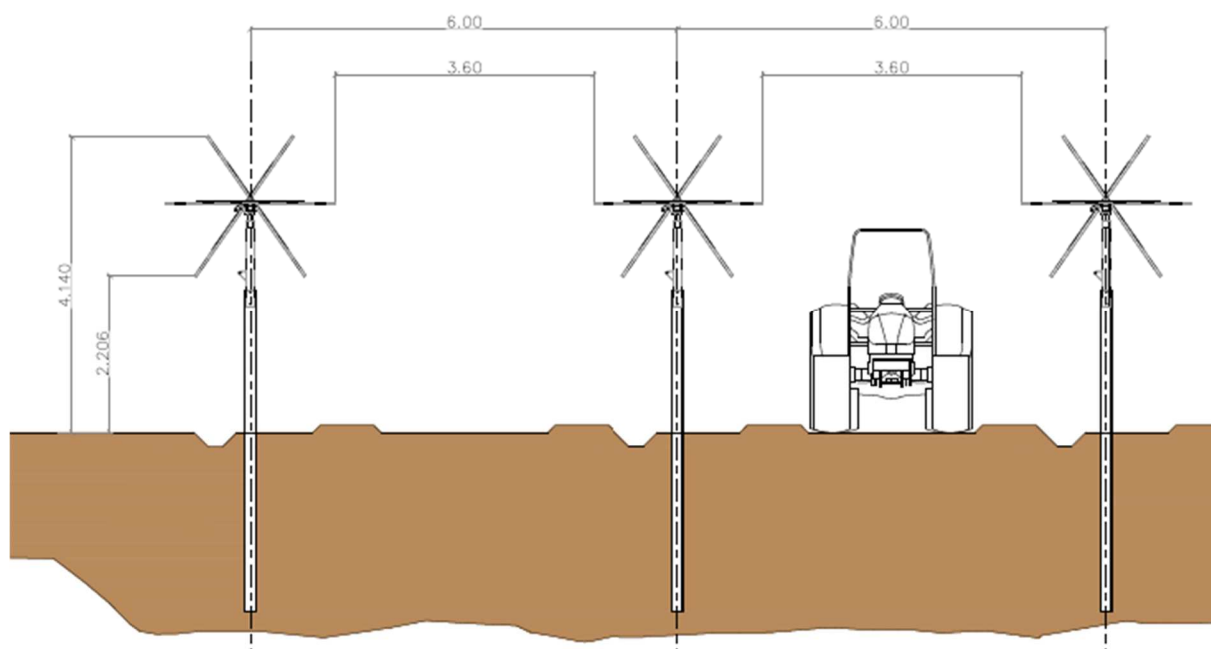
Sezione struttura sostegno moduli con palo di fondazione che raggiunge una profondità di 2 m. Altezza minima da terra 2,2 m, altezza massima da terra 4,14 m.
